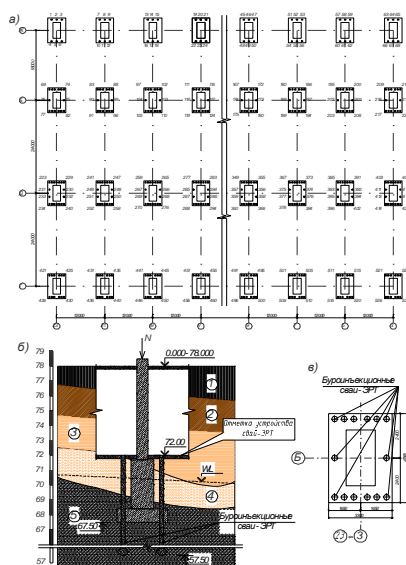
а План расположения буроинъекционных свай-ЭРТ; б – Сечение фундамента в осях Д/12 с привязкой в инженерно-геологический разрез; в – план буроинъекционных свай-ЭРТ усиления основания в осях Б/5.1- насыпной грунт; 2- суглинок полутвердый; 3- супесь; 4- глина твердая; 5- пески мелкие водонасыщенные.
